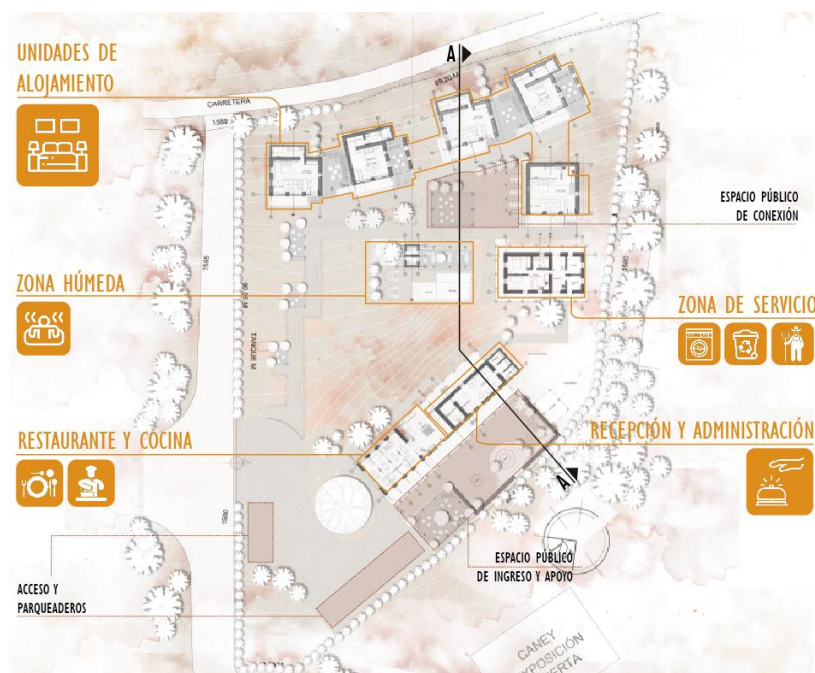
Planta general del proyecto, zonificación y distribución. Fuente: planos arquitectónicos de autoría propia según proyecto arquitectónico.
